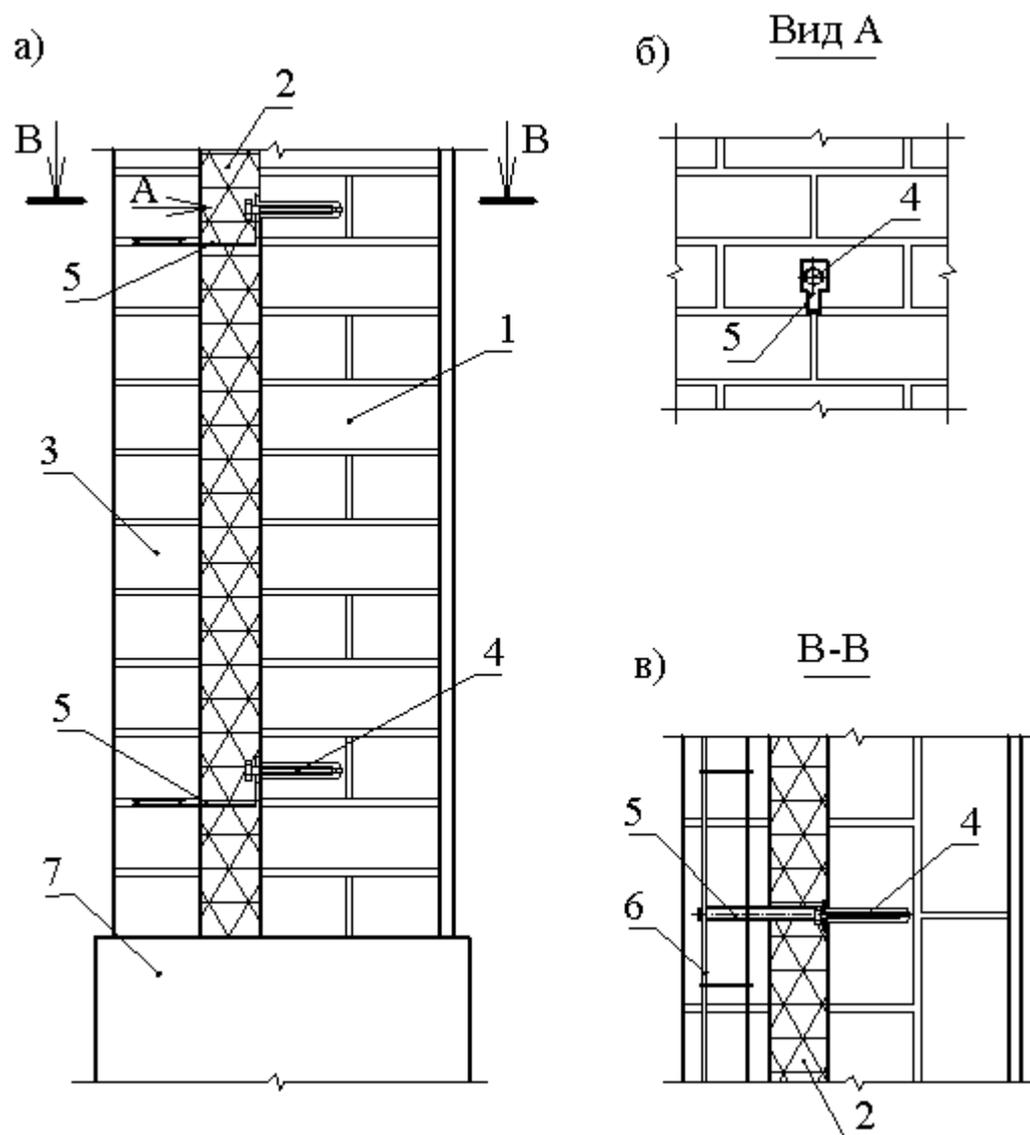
Схема наружной стены с теплоизоляцией, облицованной кирпичём:
